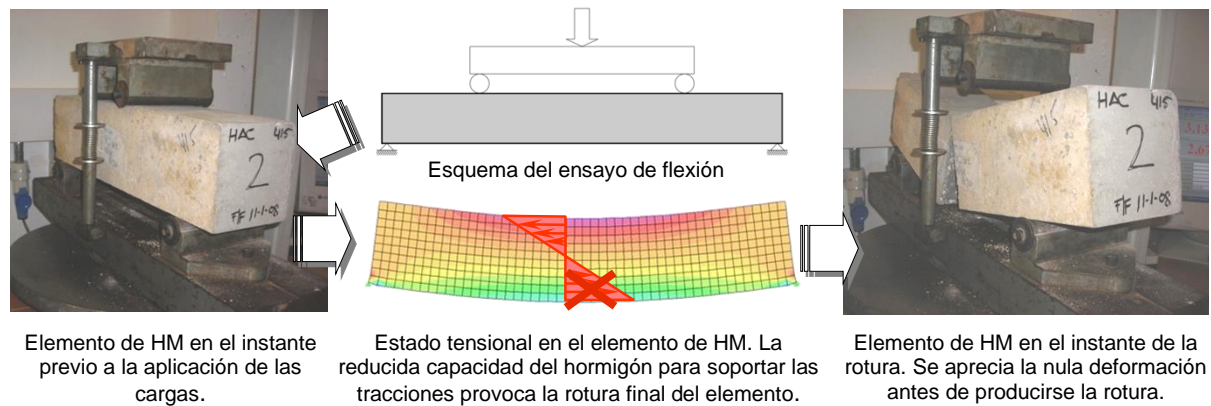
Ensayo de flexión de un elemento de hormigón en masa.
